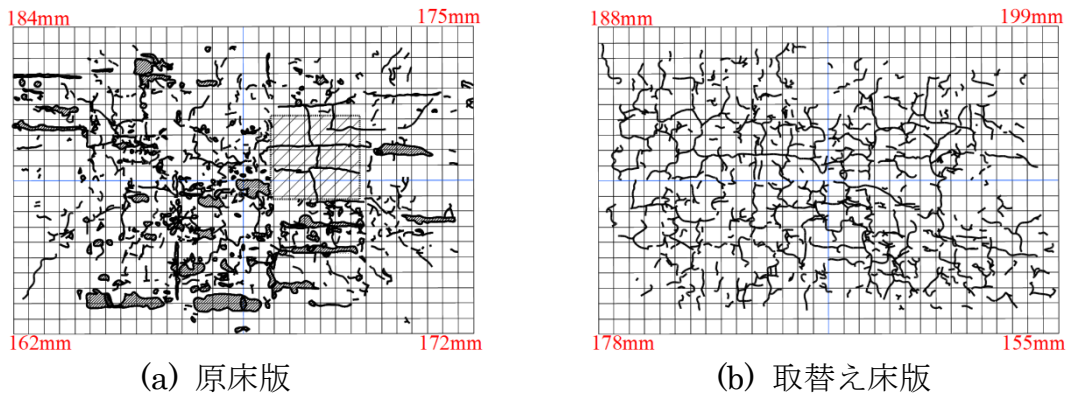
床版下面ひび割れ発生状況(疲労限界状態時)
